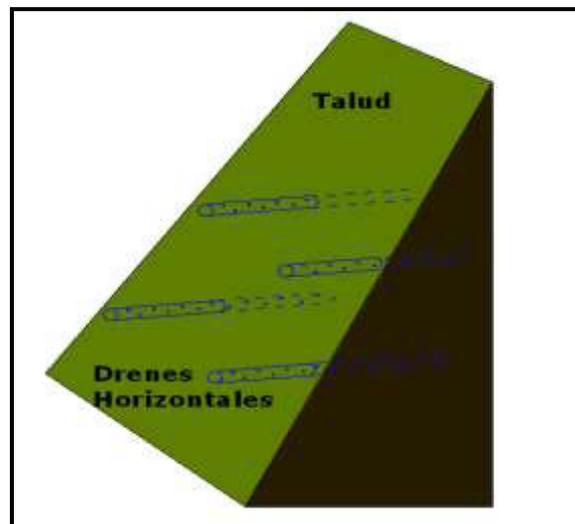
Perfil Esquemático de la implantación de Drenes Horizontales.
